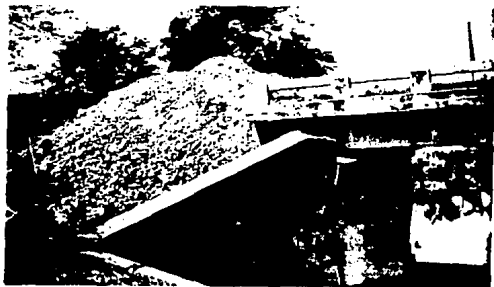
VISTA AL ASENTAMIENTO DEL ESTRIBO DESDE OTRO ANGULO.
